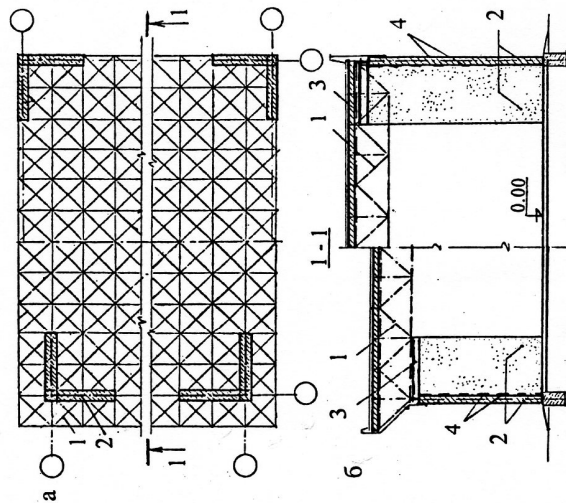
Одноэтажное бескаркасное здание с бесфакерковыми стенами из типовых панелей
